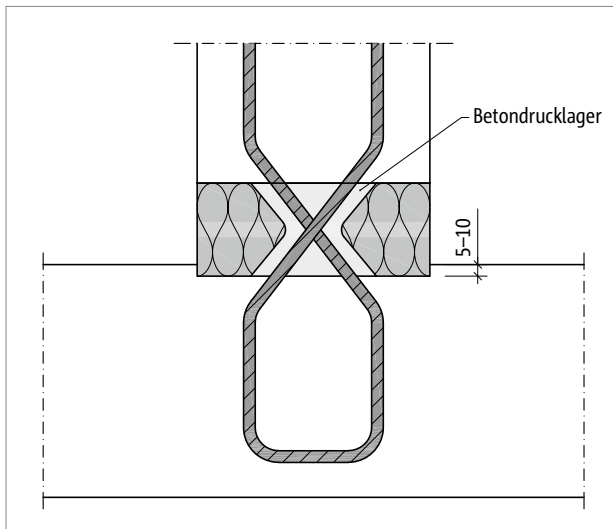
Schöck Sconnex® Typ W: Detail 1; Formschluss durch 5–10 mm tiefe Einsenkung des Dämmkörpers in die Decke
